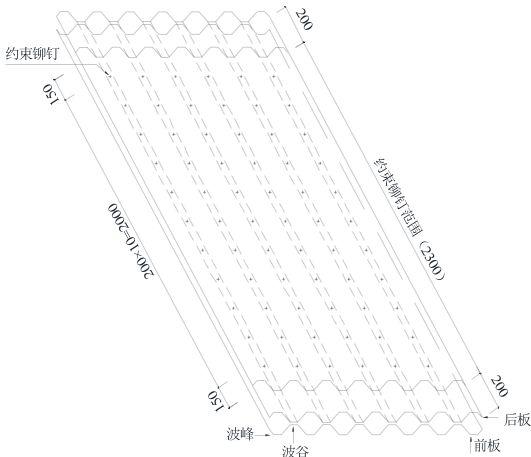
11 压型钢板前后板约束铆钉布置三维图 (单位: mm)
